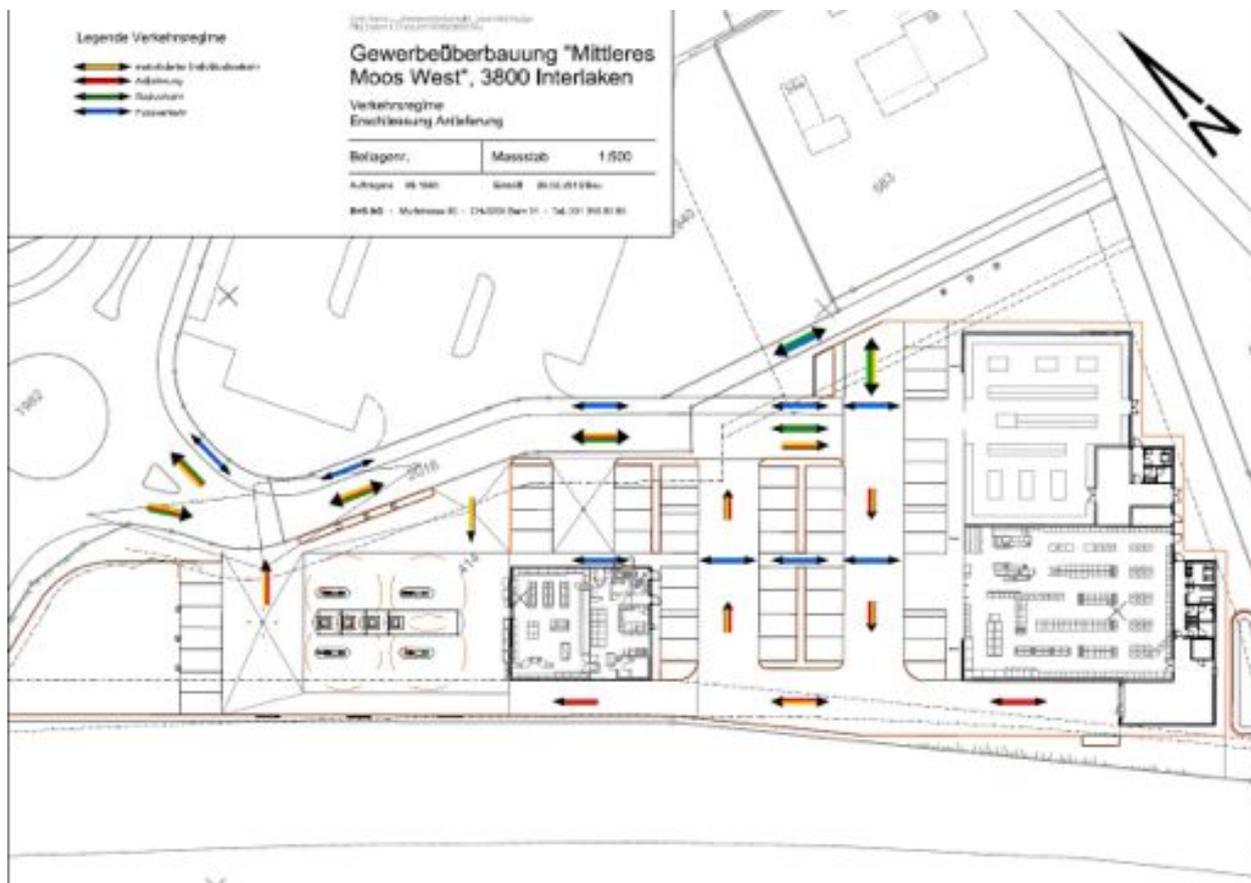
Arealinterne Erschliessung, (Quelle Plangrundlage: Architekturbüro E. Bornand)
